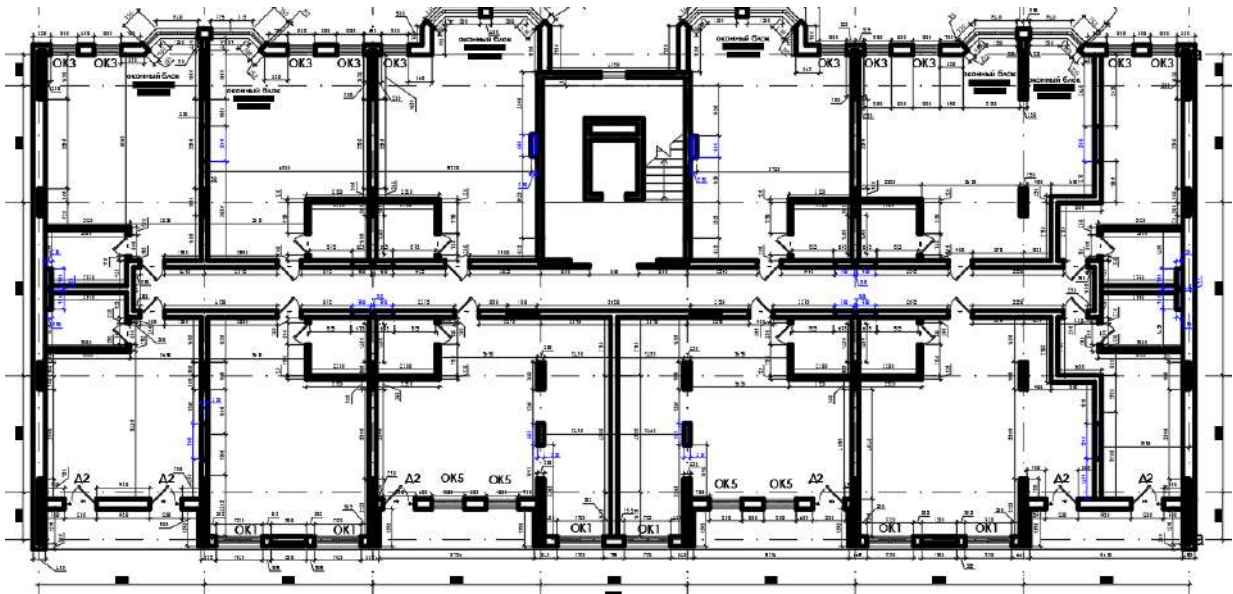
План розташування залізобетонних елементів та огорожувальних конструкцій прямої секції житлового комплексу «Авіньйон»
